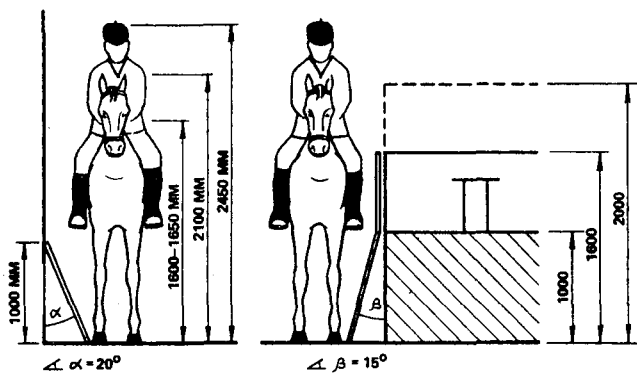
Основные размеры по высоте конюшни и углу установки дощатого забора.
